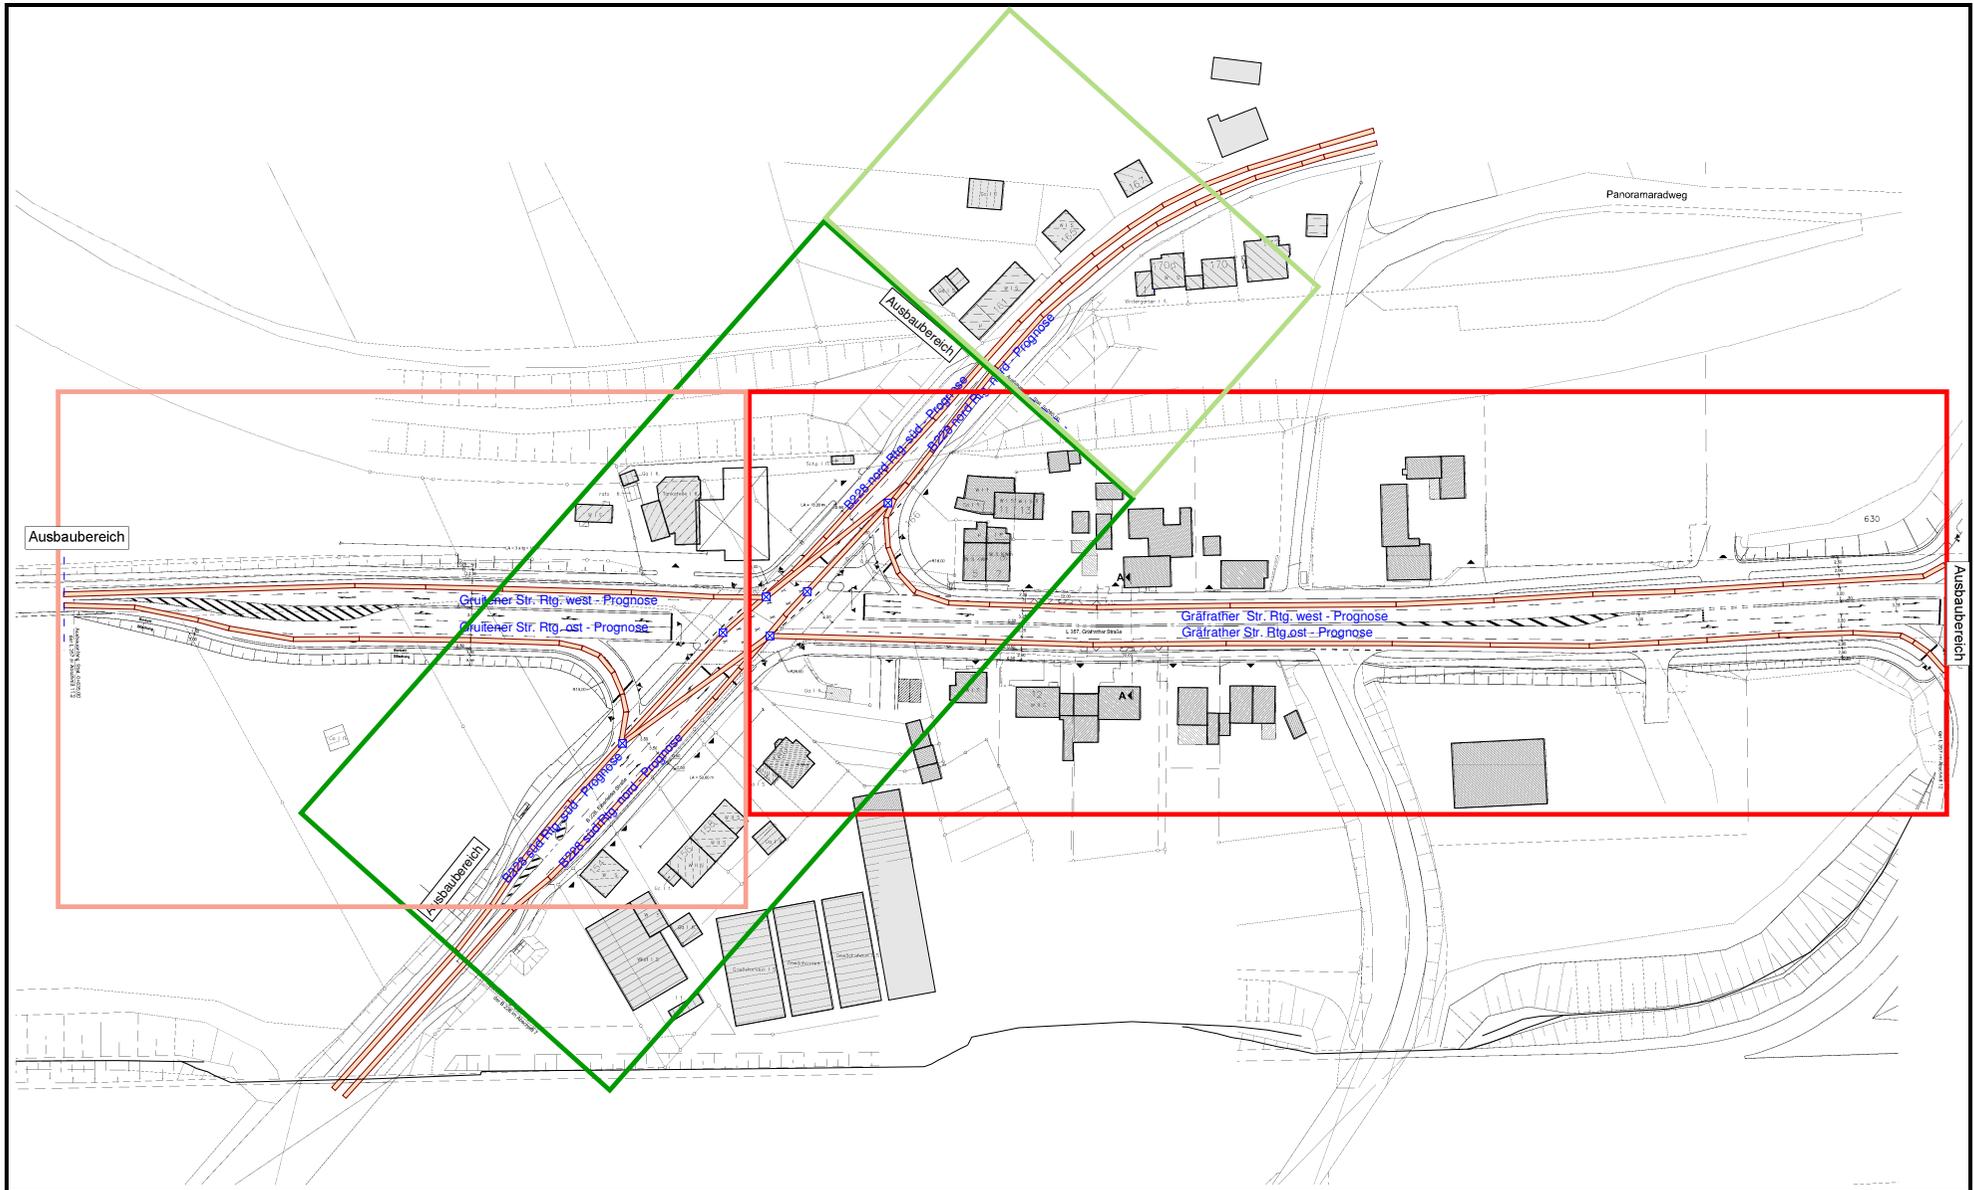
Lage der Fahrstreifen - geplanter Ausbau
